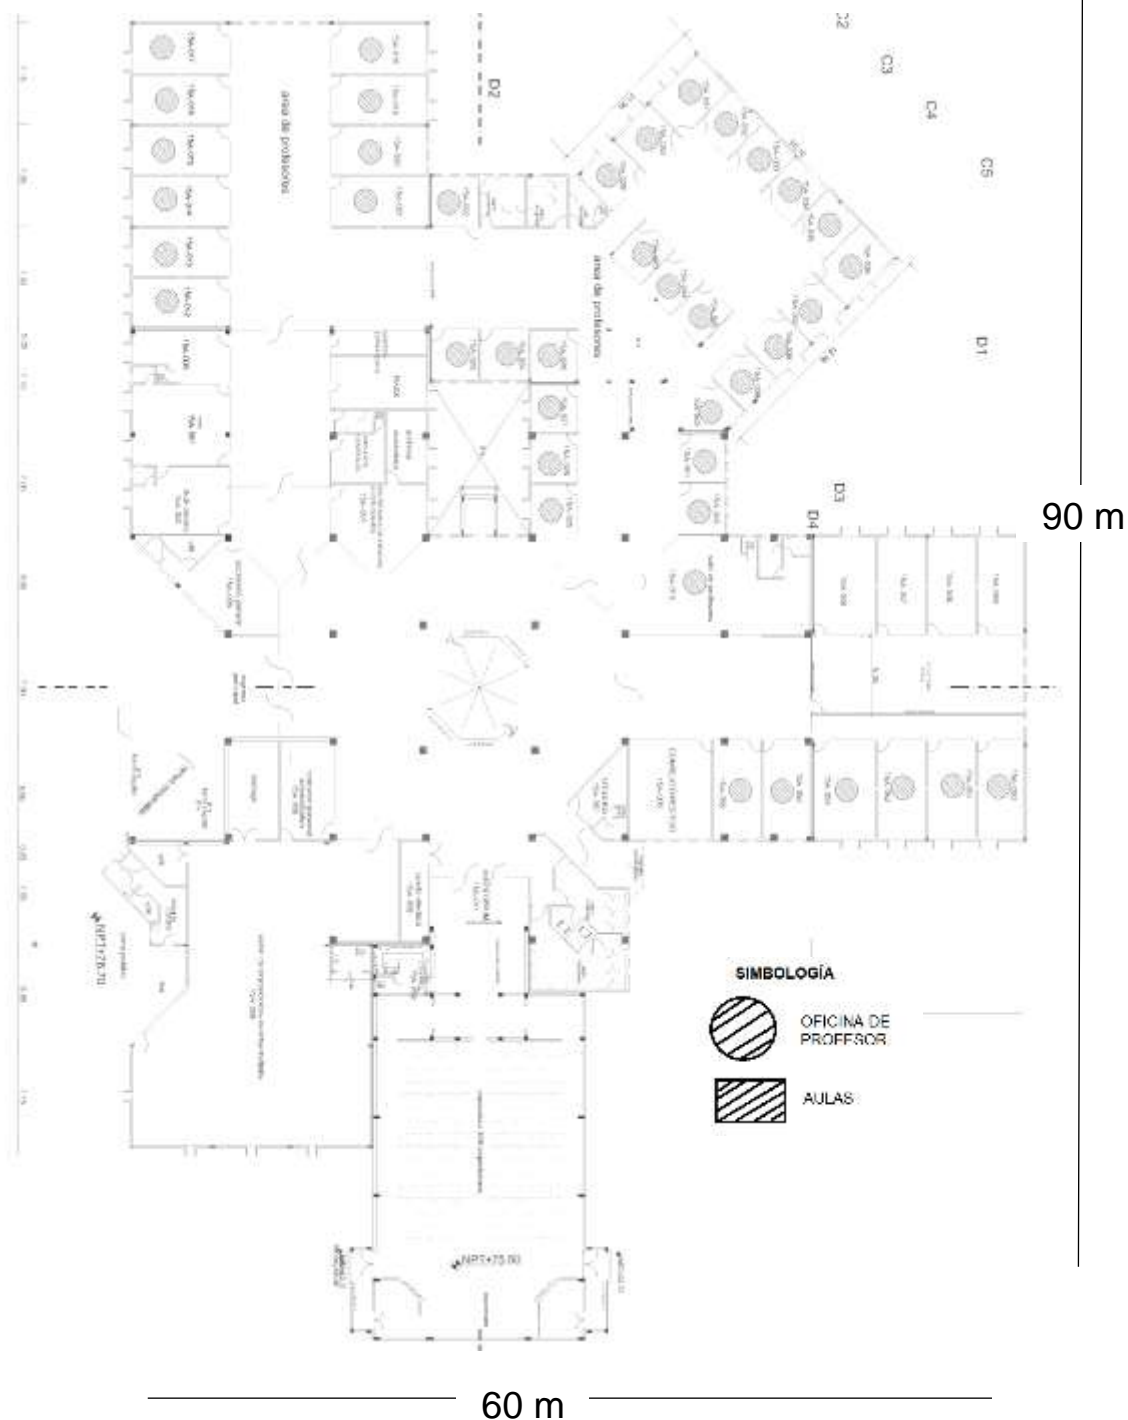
Plano Aéreo del Bloque 15A-Edificio FIEC planta baja[4]
